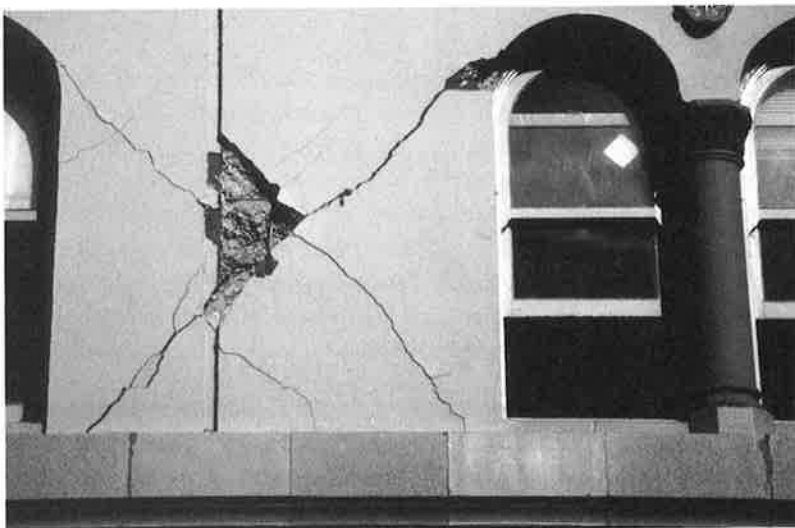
, Für horizontale Erdbebenbelastung typische Schrägrisse an den Schubwänden des 7-stöckigen in Stahlbeton ausgeführten Palomar Hotels in Santa Cruz. Betonabplatzung im Bereich der Gebäudedilatation
